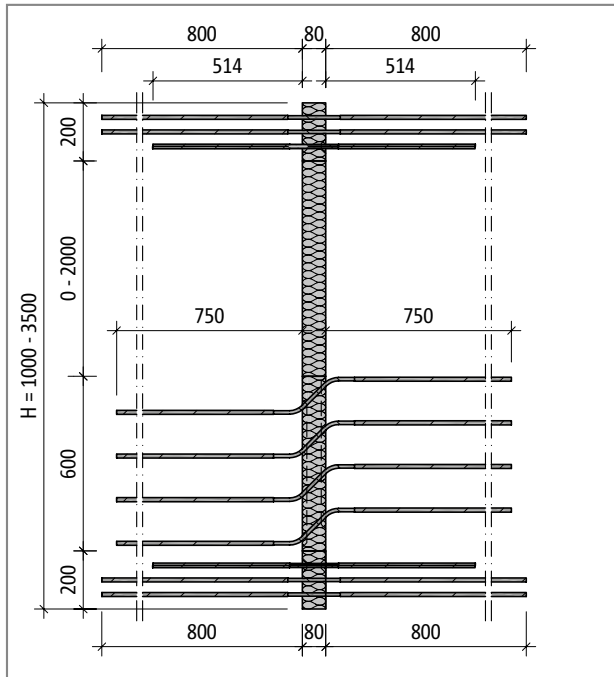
Schöck Isokorb® tipo W30L: sezione dell'elemento
